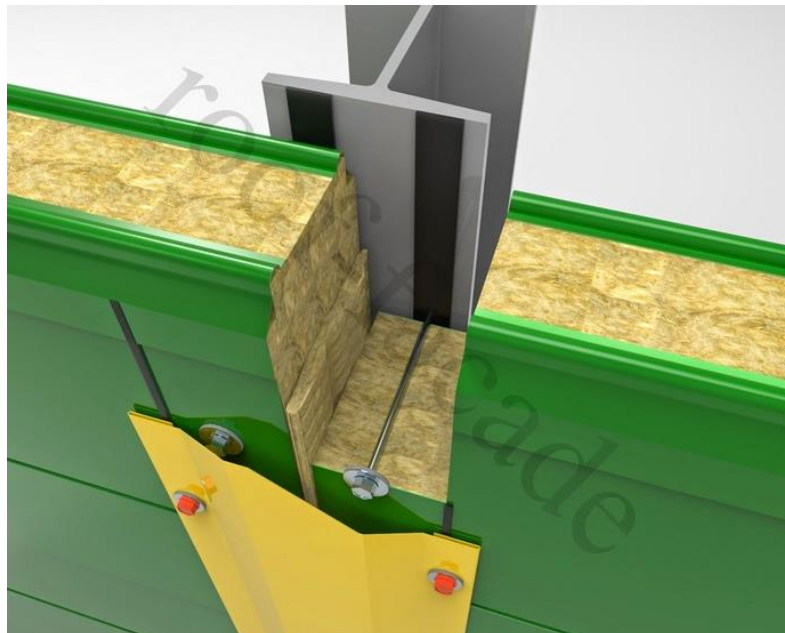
Кріплення стінової сендвіч-панелі до сталевій колони за допомогою самосвердлячих самонарізаючих шурупів
